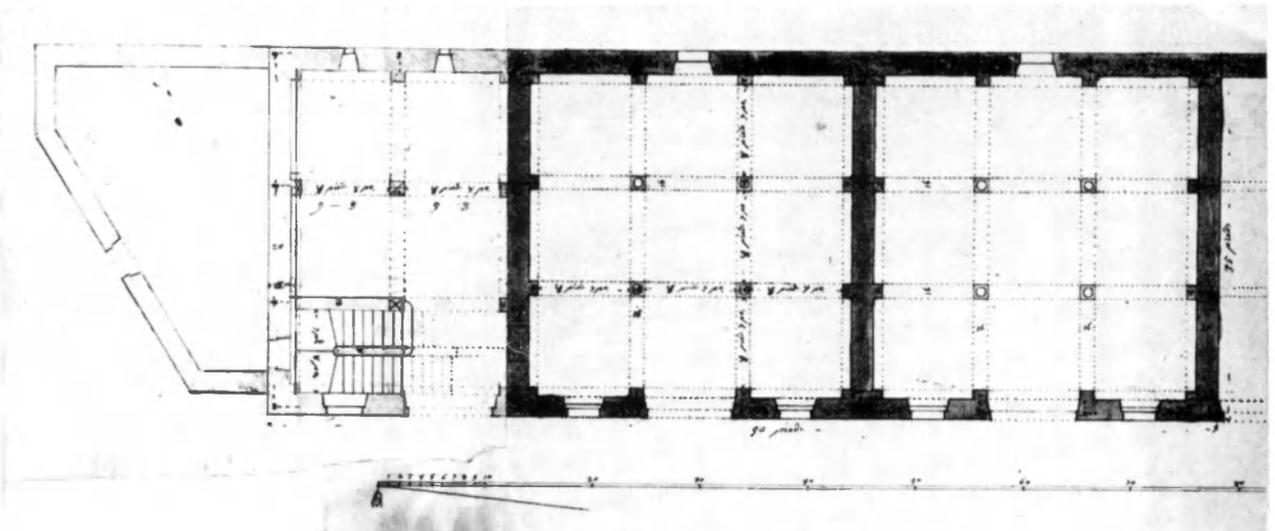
Plan de Chermans (coupe de l'orangerie).
